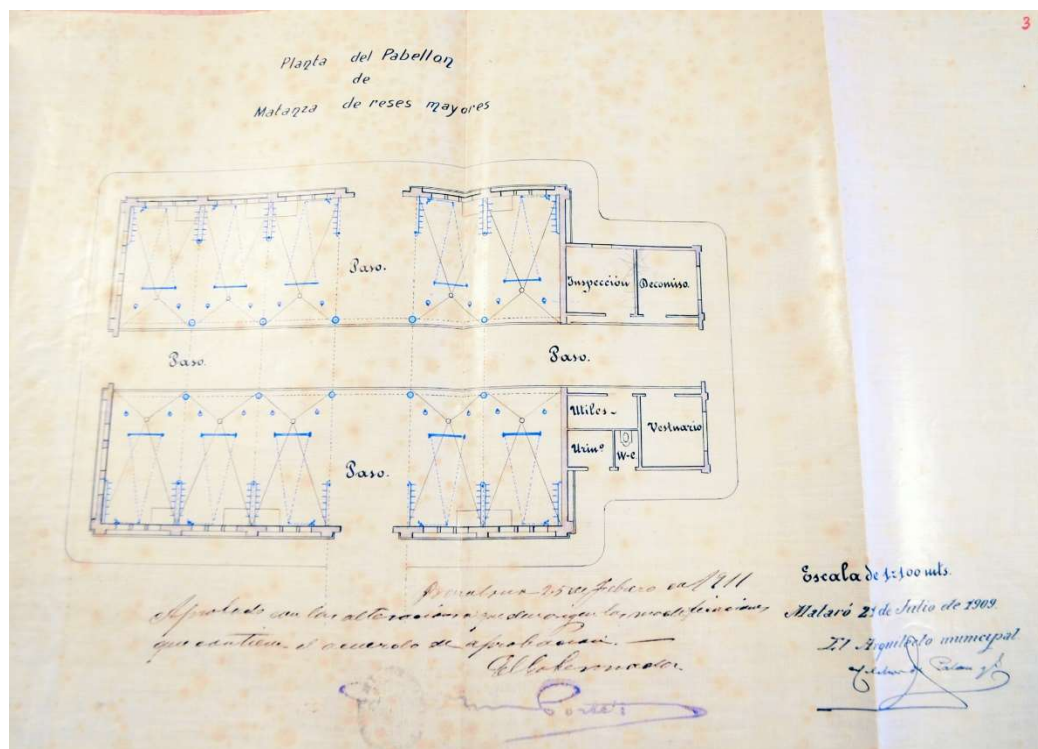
Plano de la distribución en planta del pabellón de matanza de reses mayores. [12]
